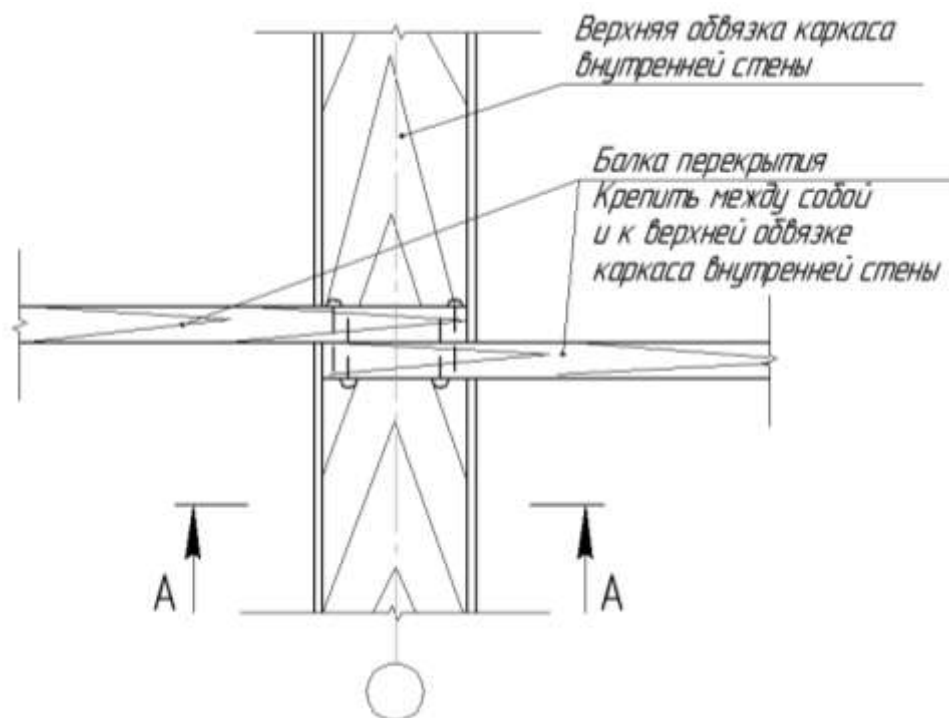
Опирание балок перекрытия на внутренний каркас стены
